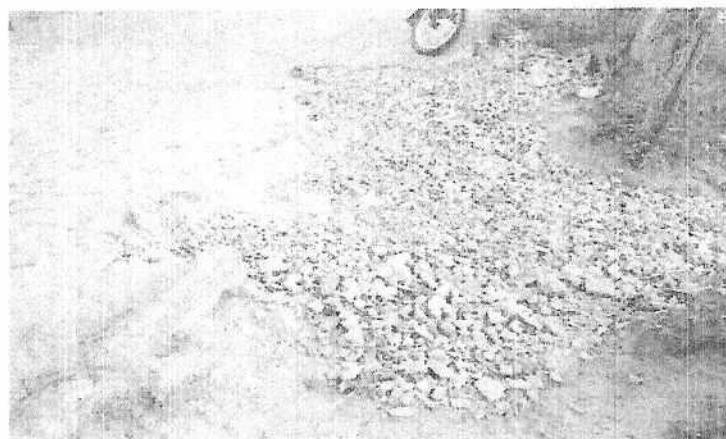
Pavimento com elevada desagregação da pedra e ausência de meio fio
